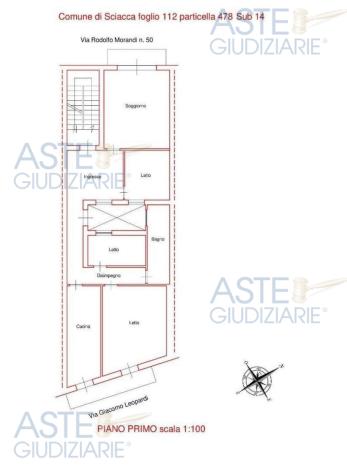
Rilievo digitale dello stato di fatto part.lla 478 sub. 14
